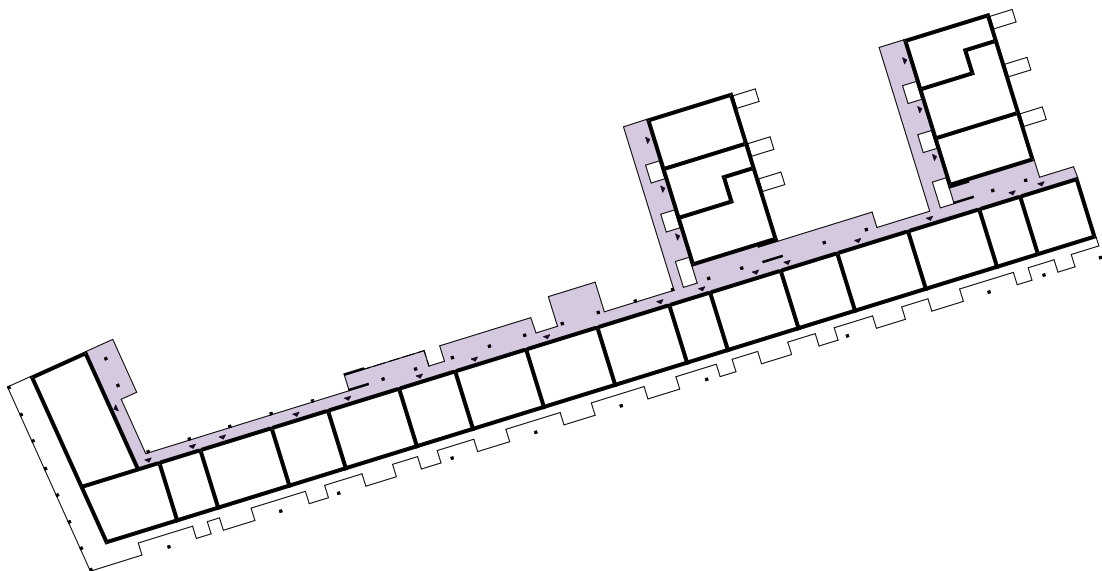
Grundriss Hauptbahnhof II, M 1:1000
